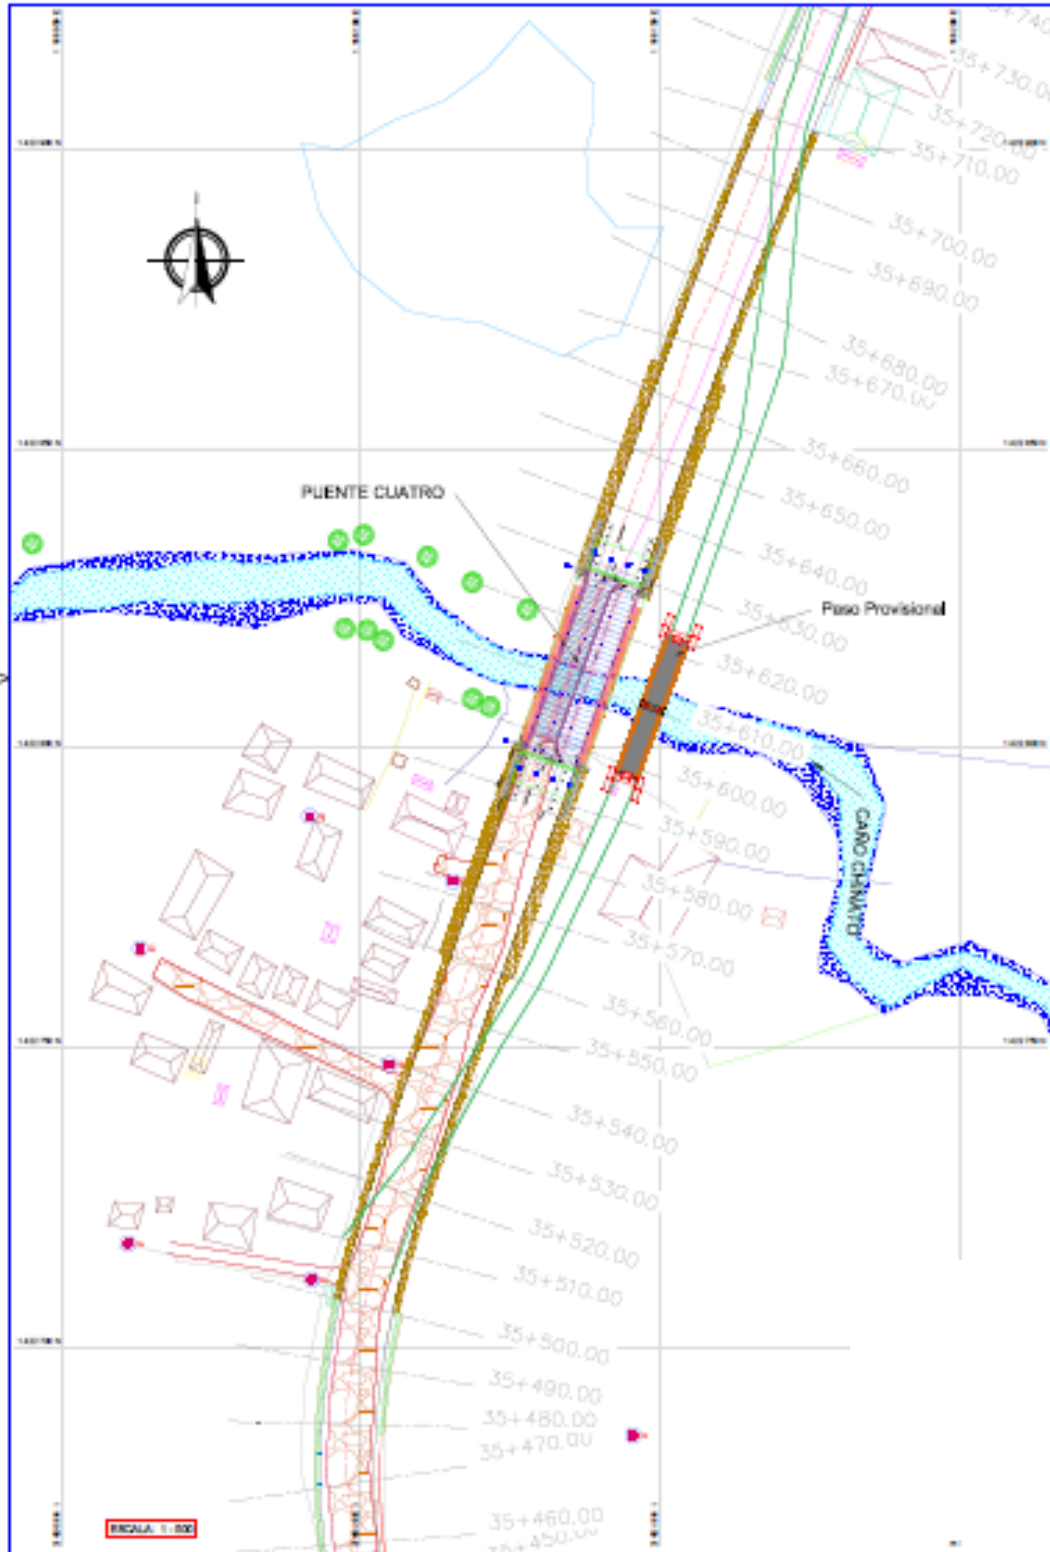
Planta general de localización de proyecto Tramo vial K35 + 480 – K35 + 710 Puente 4, Vía Astilleros – Tibú.
